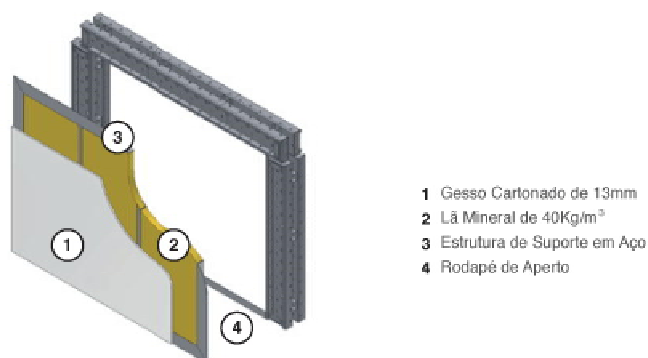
Pormenor construtivo de uma parede interior (TÉKETO, 2010)
